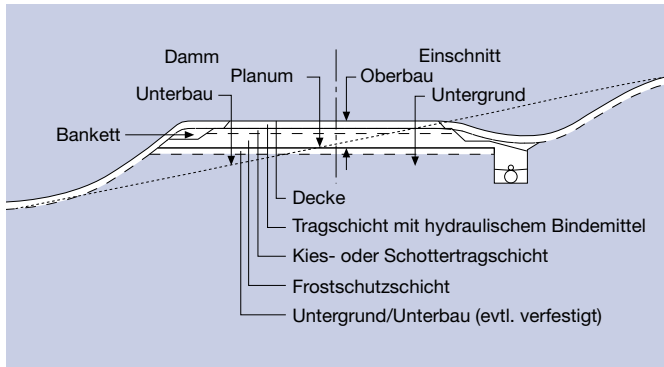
Beispielhafter Aufbau einer Befestigung mit Betondecke außerhalb geschlossener Ortslage im klassifizierten Straßenbau – Damm/ Einschnitt
